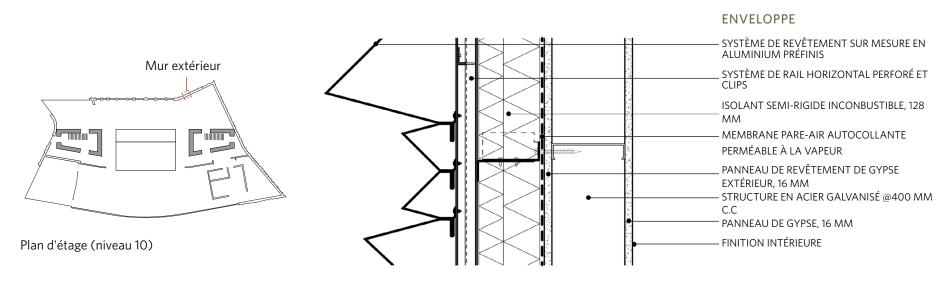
Enveloppe du bâtiment, détail de construction modifié (Source : ACTON OSTRY + Patkau Architects).
